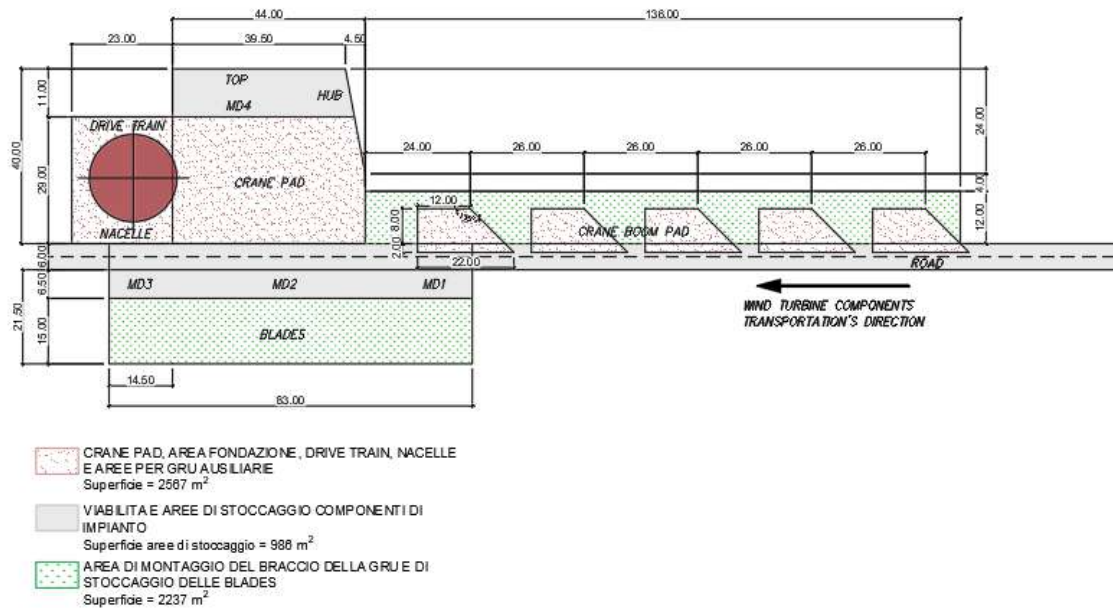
Layout della piazzola dell'aerogeneratore in fase di costruzione
